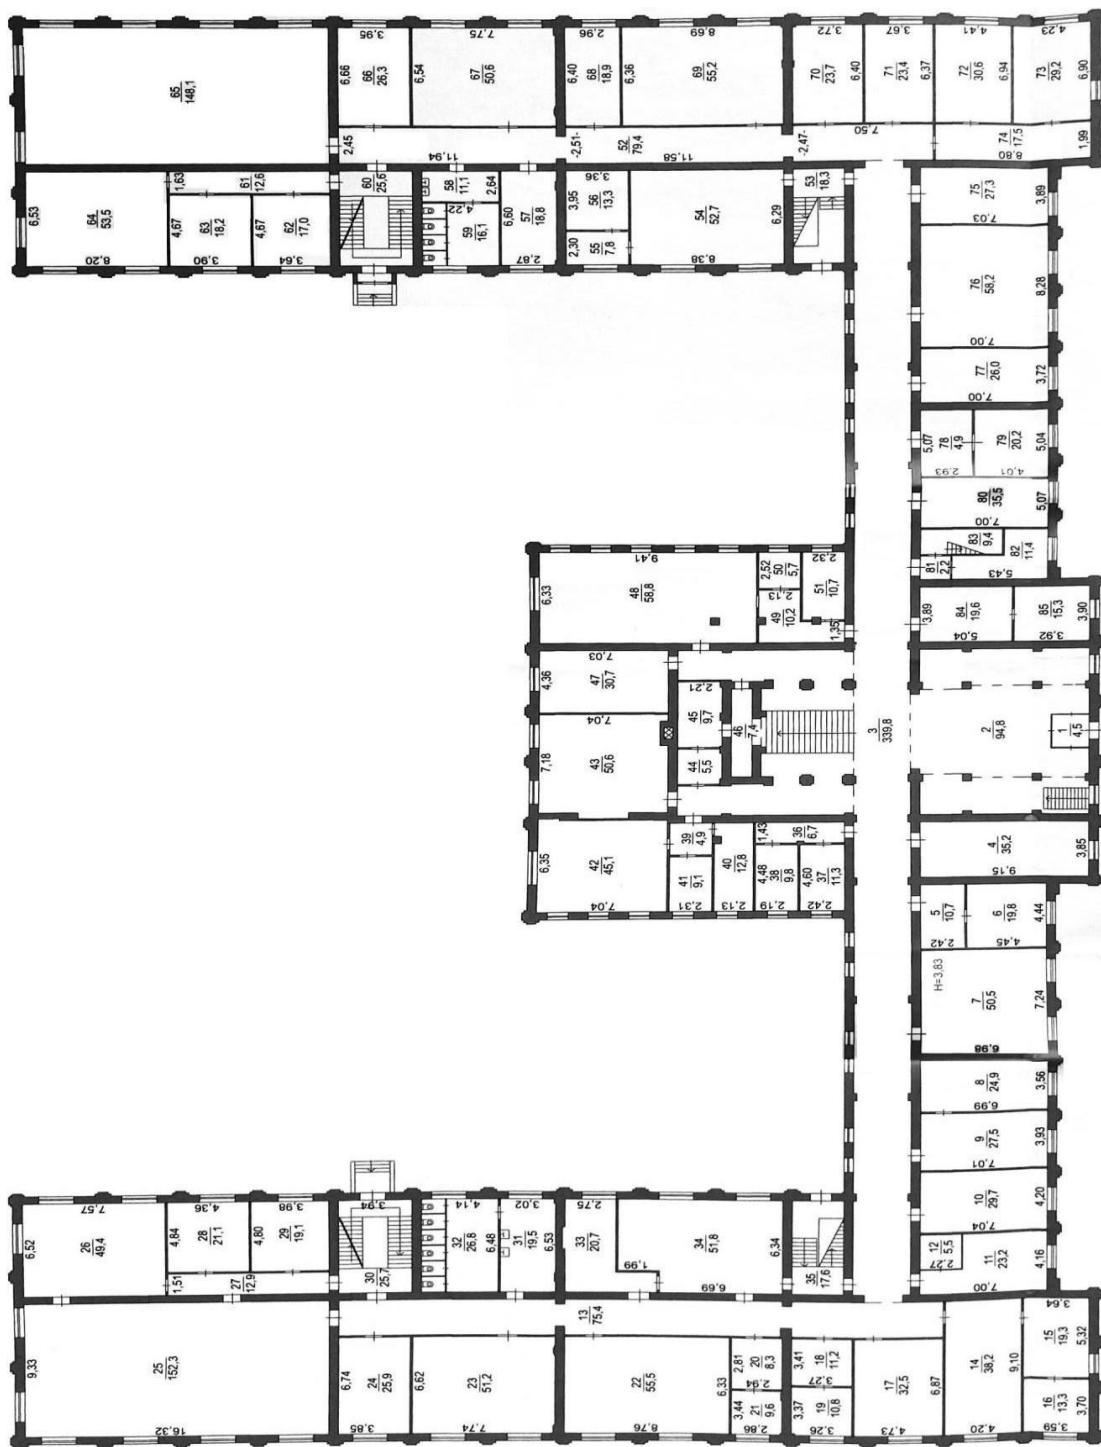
План 1 поверху навчального корпусу НУБіП України
